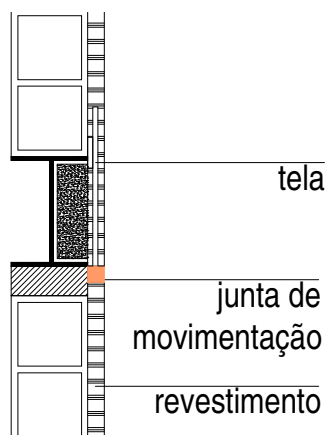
Junta de movimentação no revestimento de fachadas
